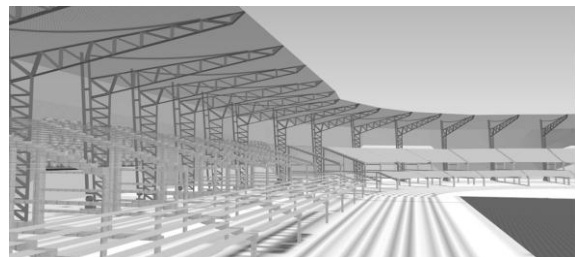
esquema cubierta y cerchas 3d. Fuente: Elab. propia.
